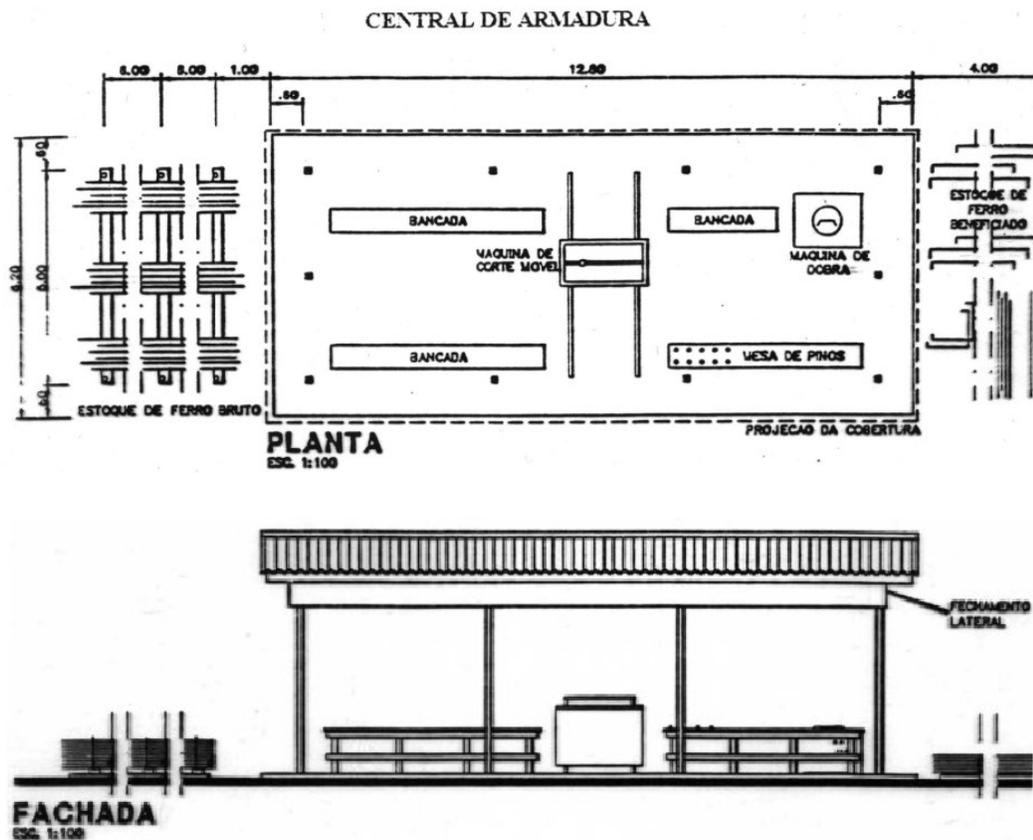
Planta e vista da fachada de uma central de processamento do aço no canteiro de obras. Fonte: BARROS e MELHADO (2006).
